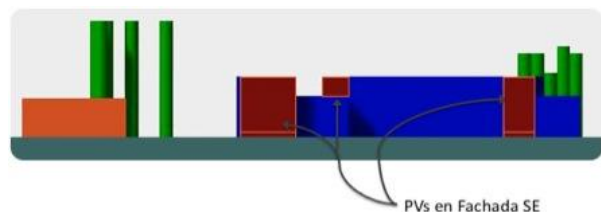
Colocación de PV en fachadas SE con menos obstrucción solar. Fuente: Elaboración Propia
